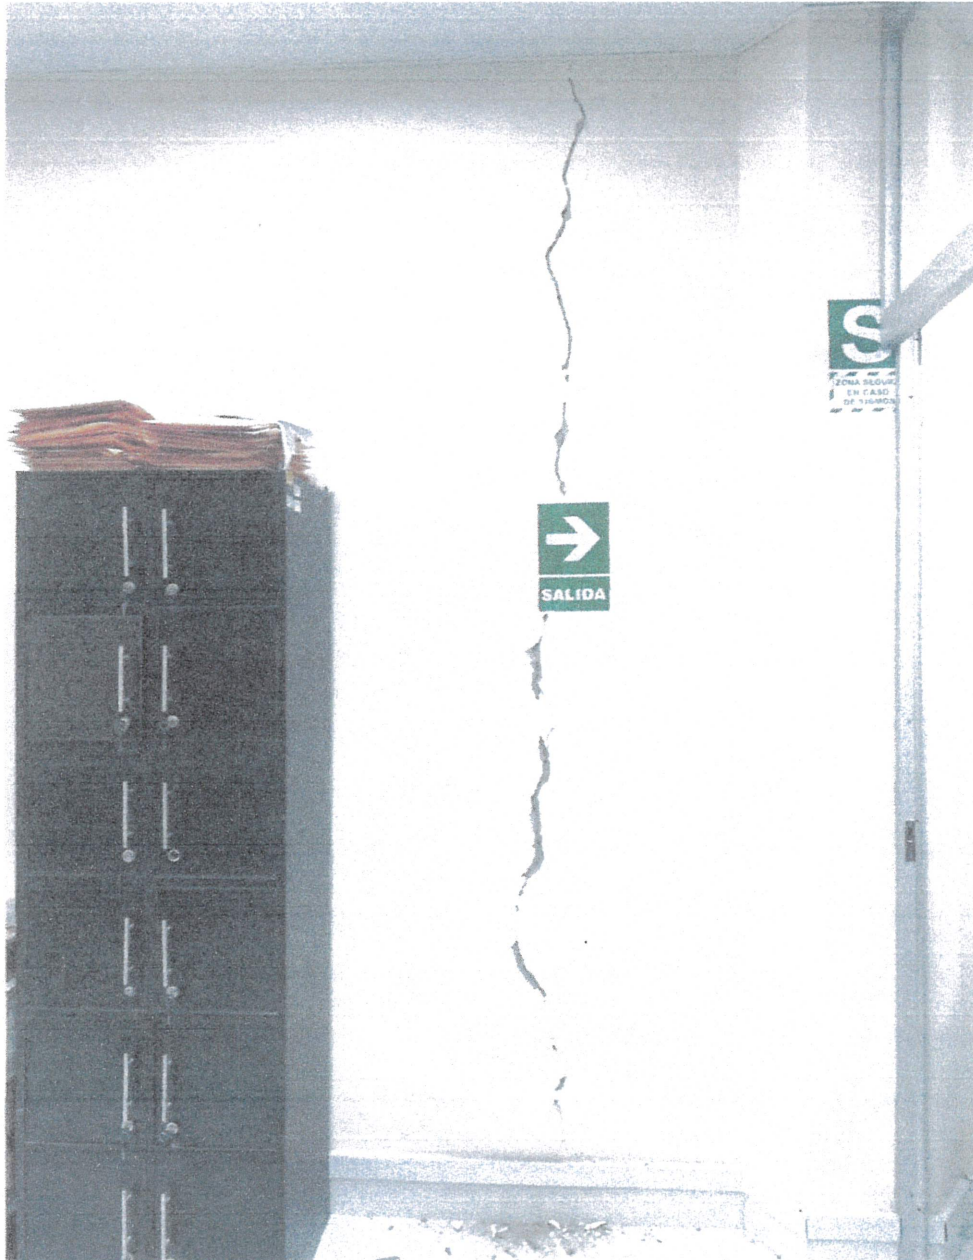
Presencia de grieta verticales en el muro de albañilería por posible instalación de tubería posterior a la ejecución del muro.
